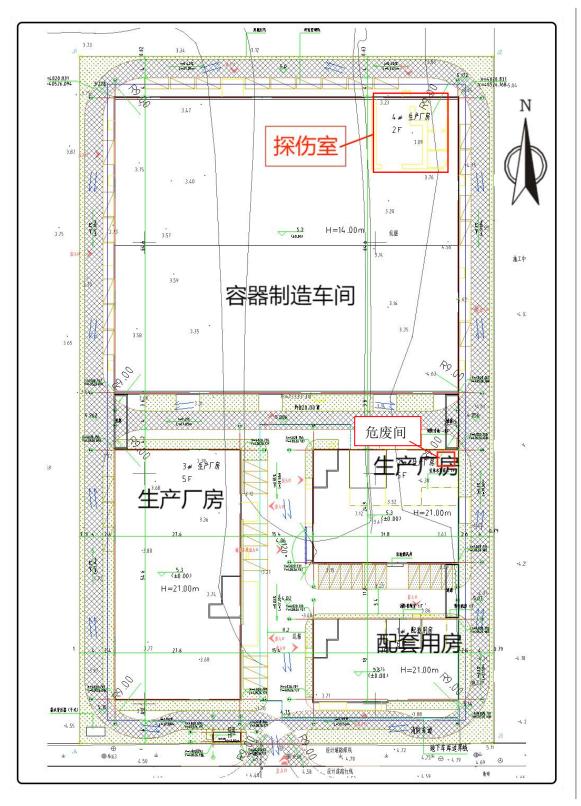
青岛德尔诺生物医药科技有限公司总平面布置示意图
